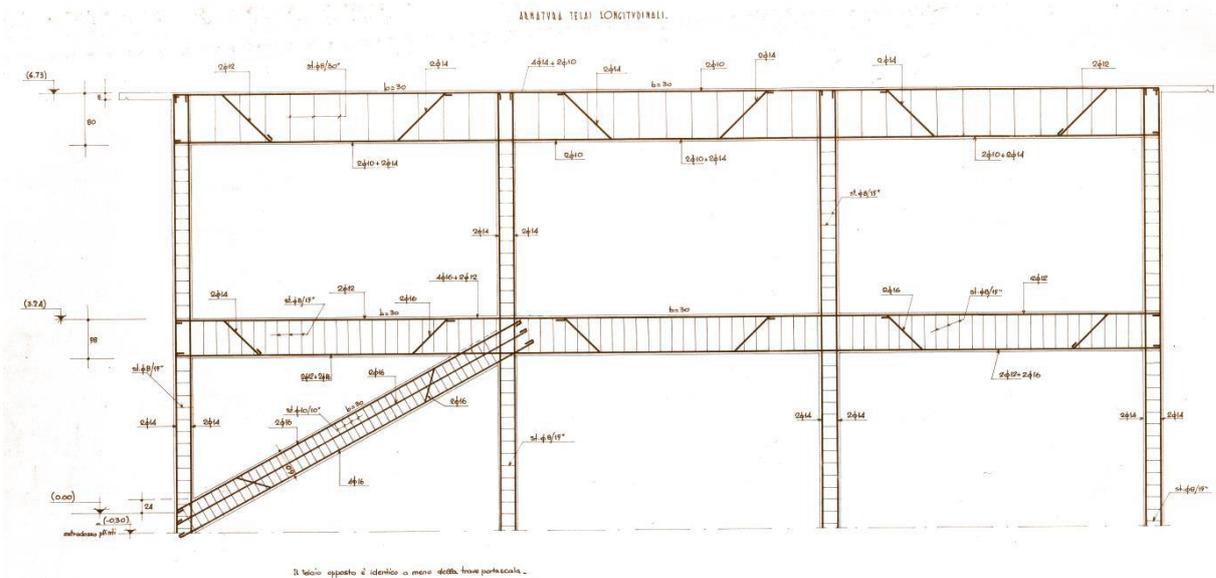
Sala Controllo e Uffici – Sezione Strutturale Tipica
